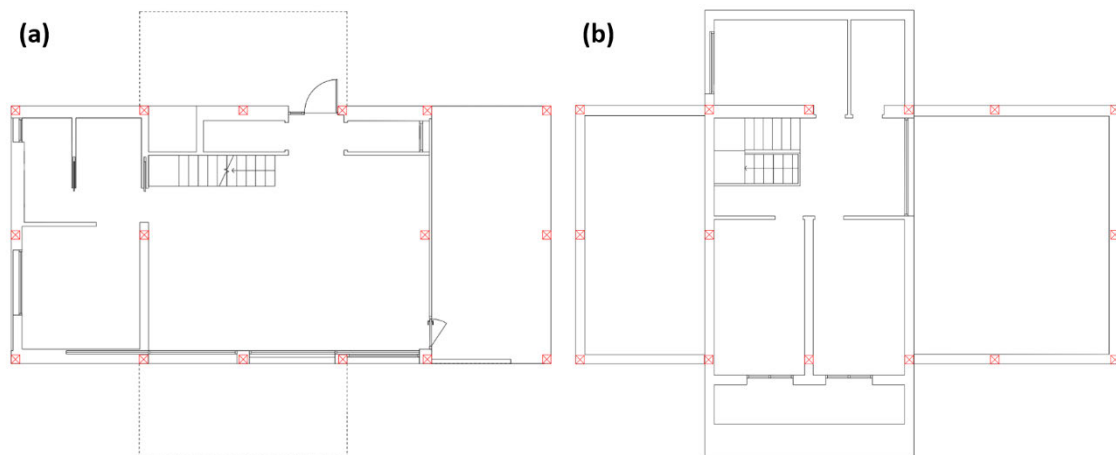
Plantas dadas como enunciado del proyecto: (a) planta baja; (b) planta primera.
